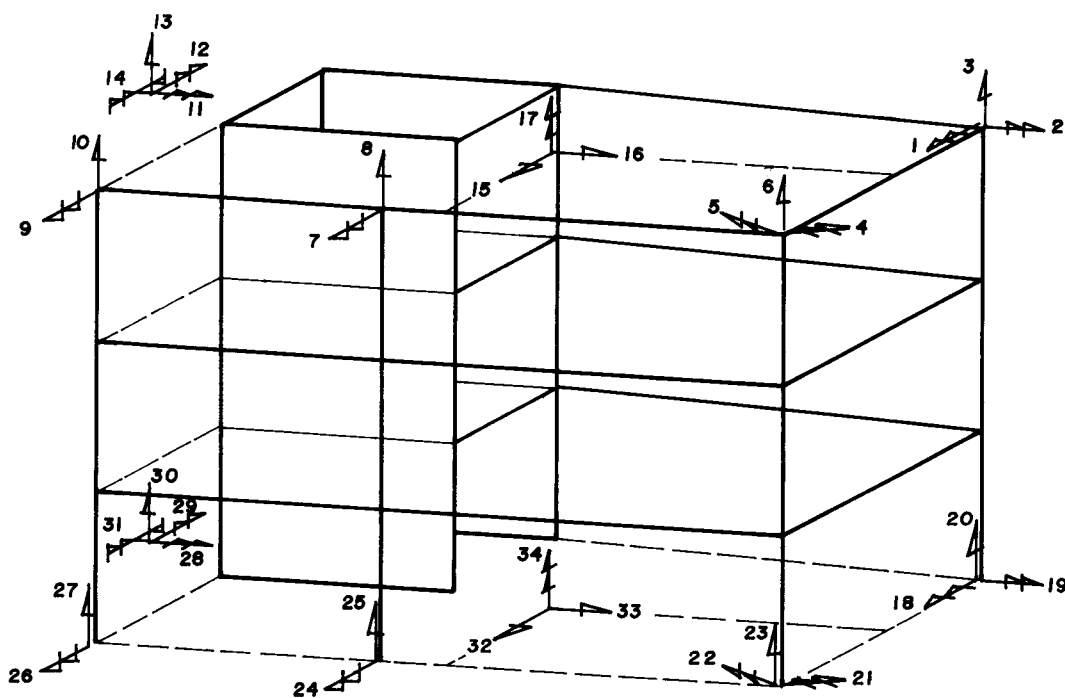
Subestrutura: coordenadas de topo e de base
